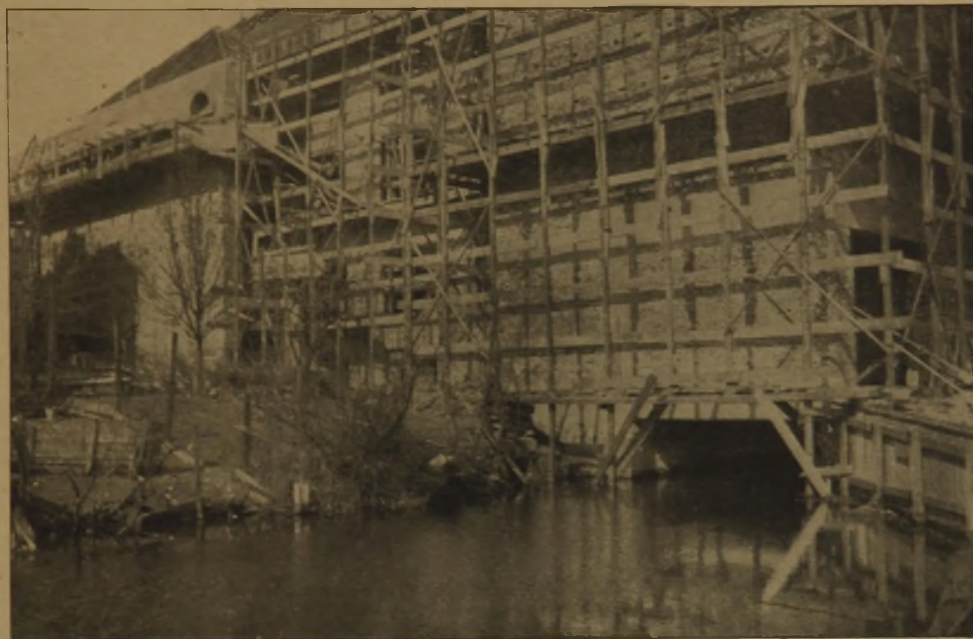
Überbauung des Mühlenbaches und Ausführung des Gesamtbaues.
